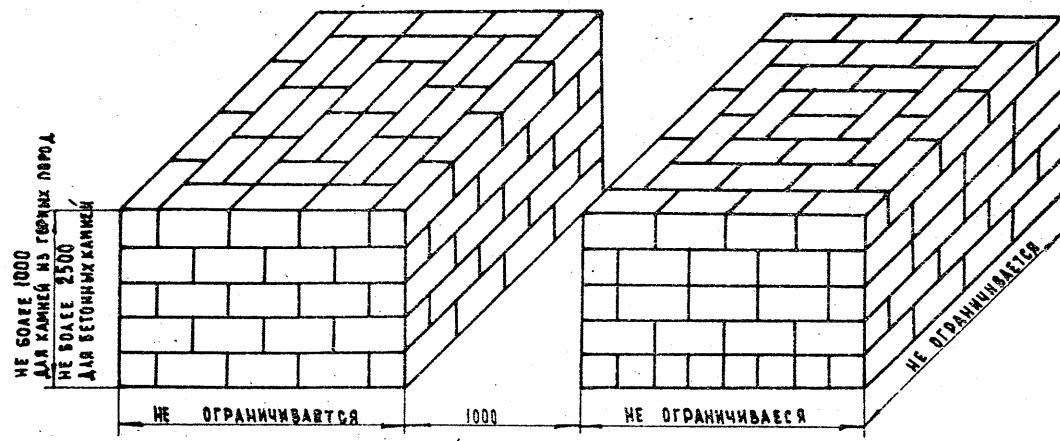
Складирование стено́вых камней из горных пород и бетонных в штабелях
